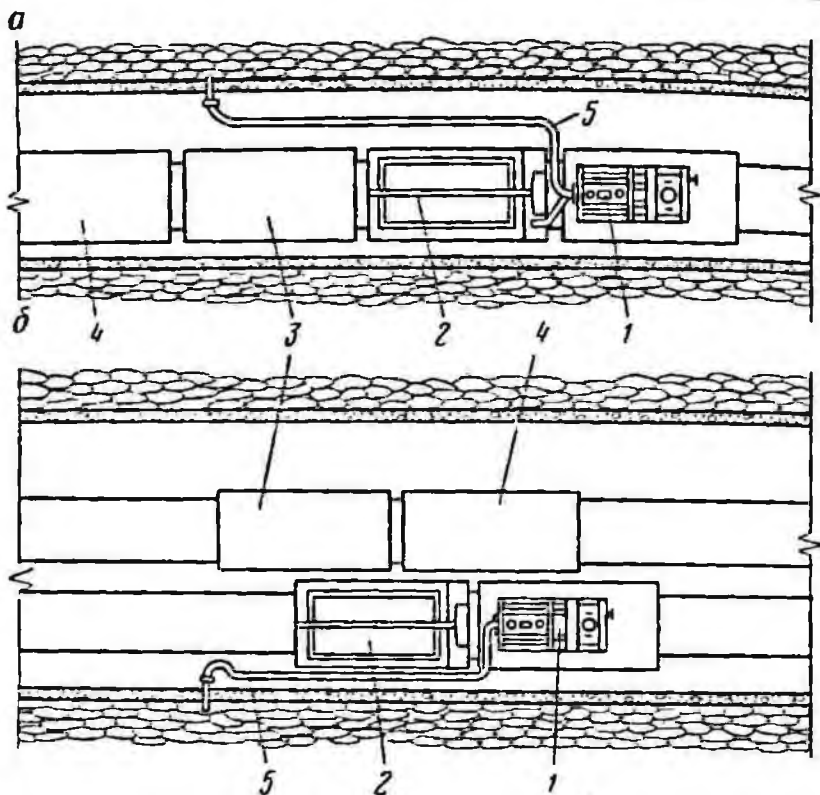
Схема размещения оборудования при последующем тампонаже горизонтальных выработок:
